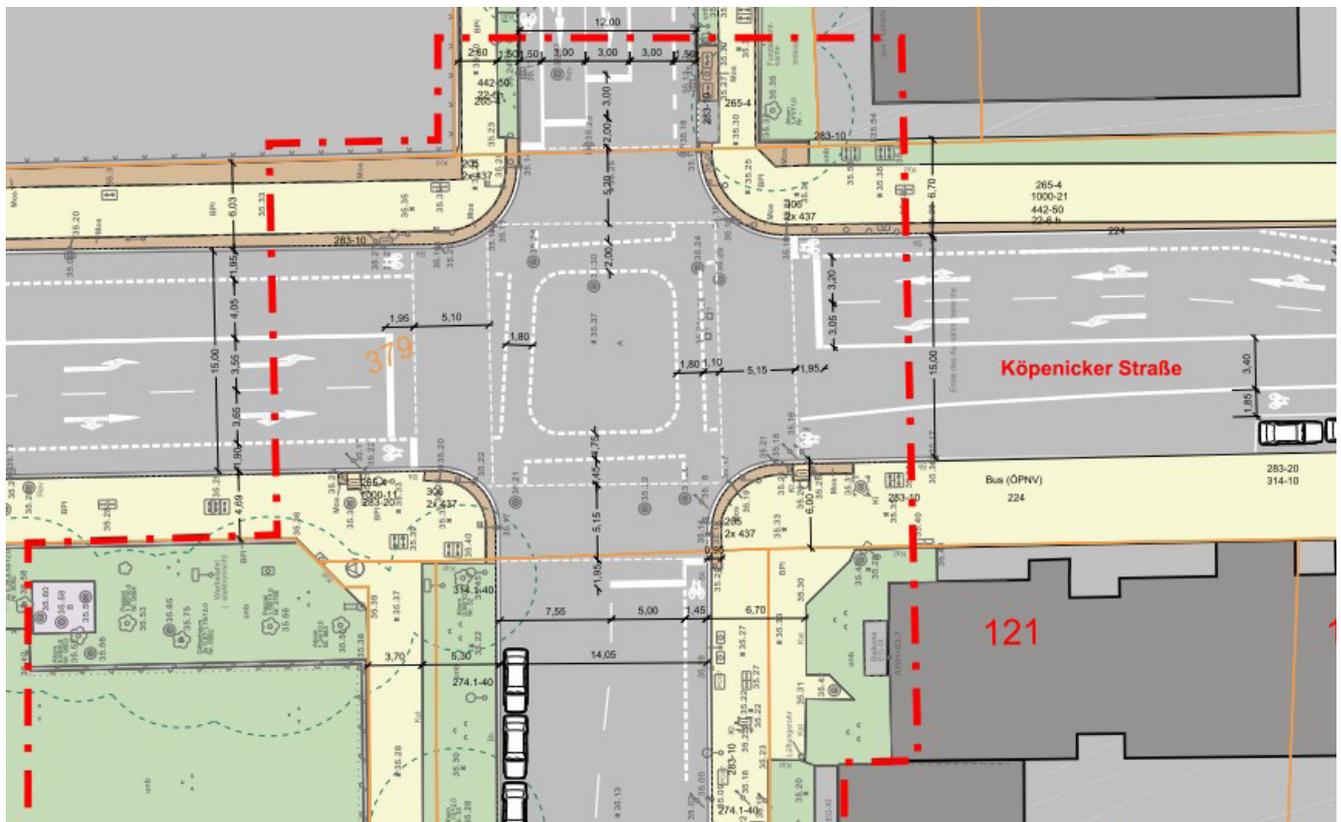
Ausschnitt Lageplan Bestand: Knoten Köpenicker Straße / Michaelkirchstraße
